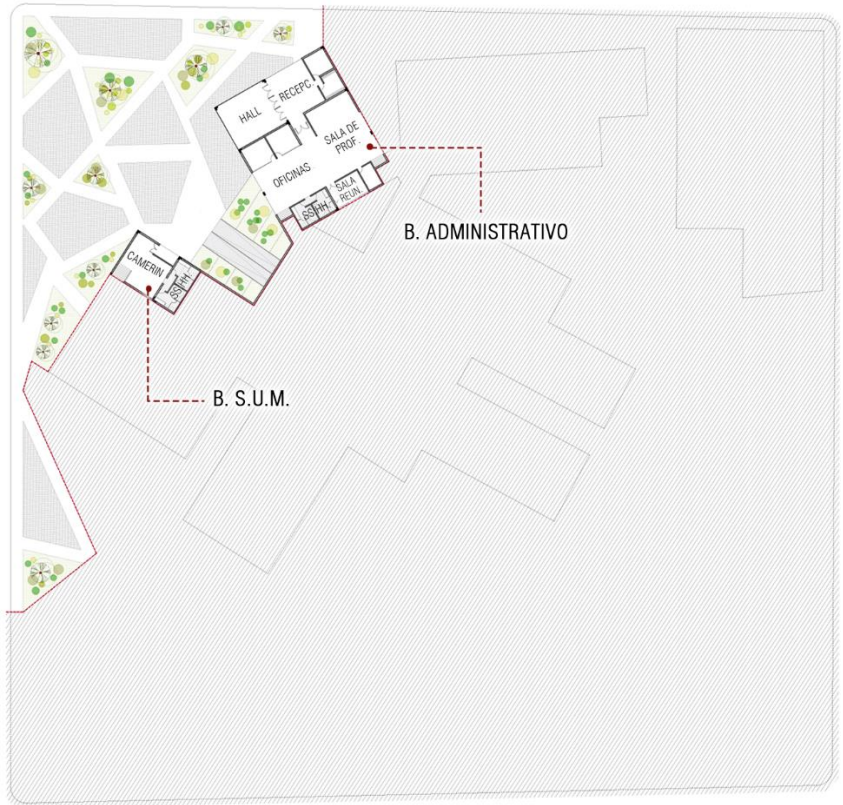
Planta del Proyecto - Cota 1m. Fuente: Propia
